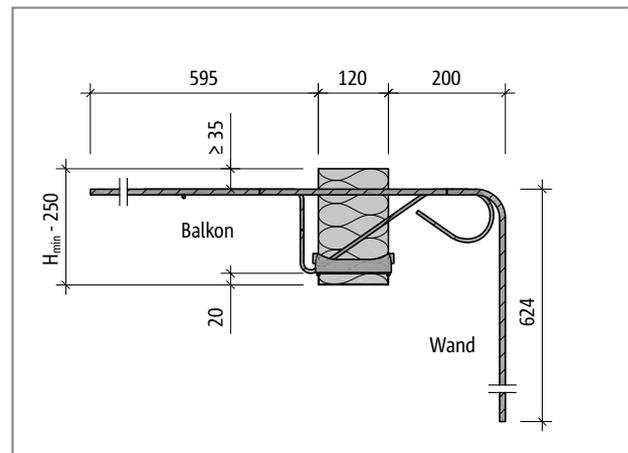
Schöck Isokorb® Typ KXT30-WU : Produktschnitt
